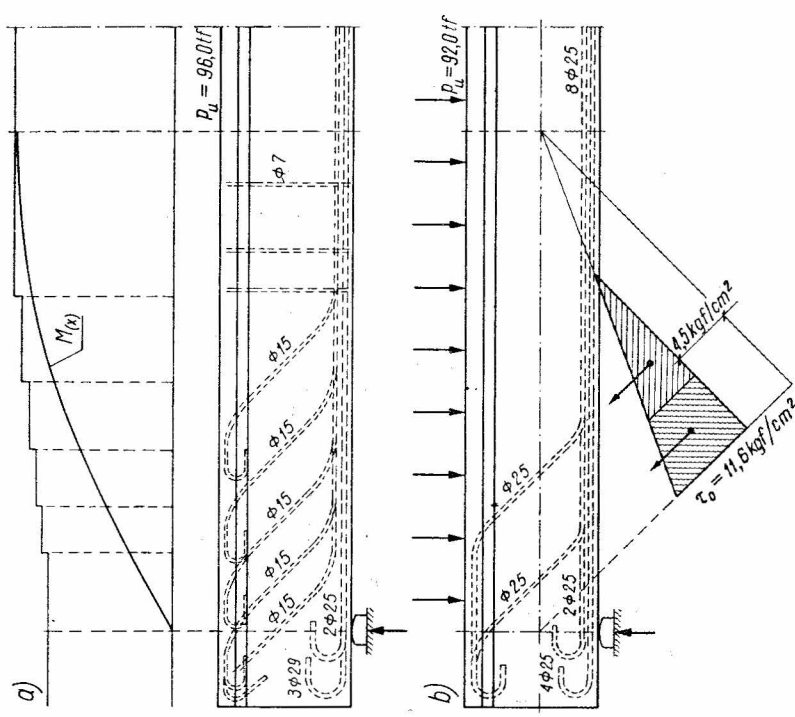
Poutres dans les essais de DAFÉ, cahier 48 [4] : a) poutre No 1031 avec le cisaillement transmis à 37 % par l'armature, b) poutre No 1032 armée d'après les indications du règlement de la Prusse de 1907
